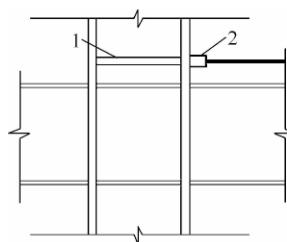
对应钢筋连接套筒位置的加劲肋设置
